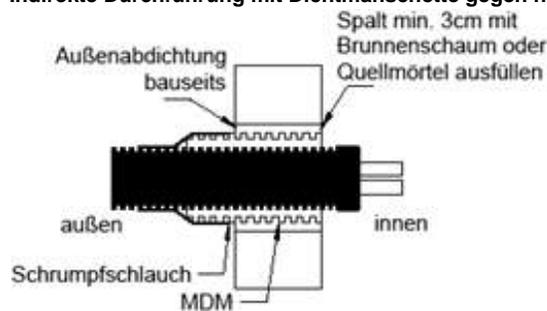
Skizze Mauerdurchführung nicht drückendes Wasser
